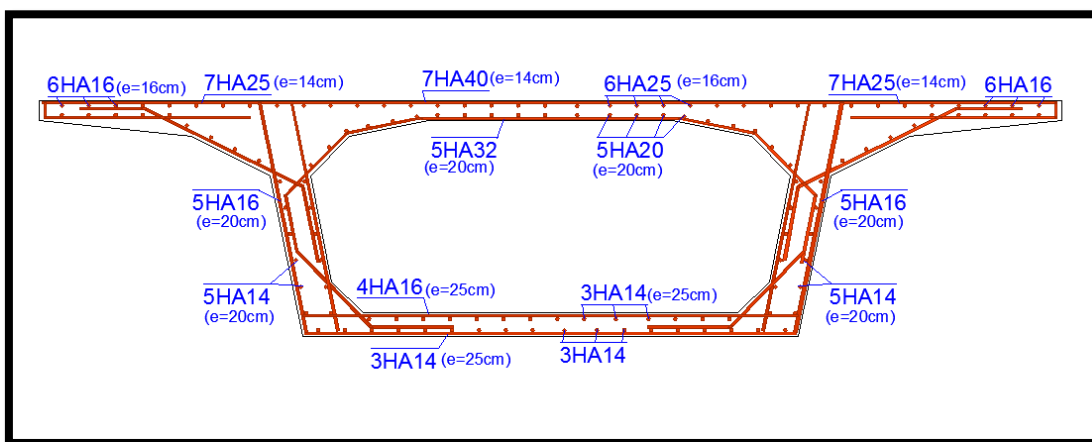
Schéma de ferrailage du voussoir à la clé
